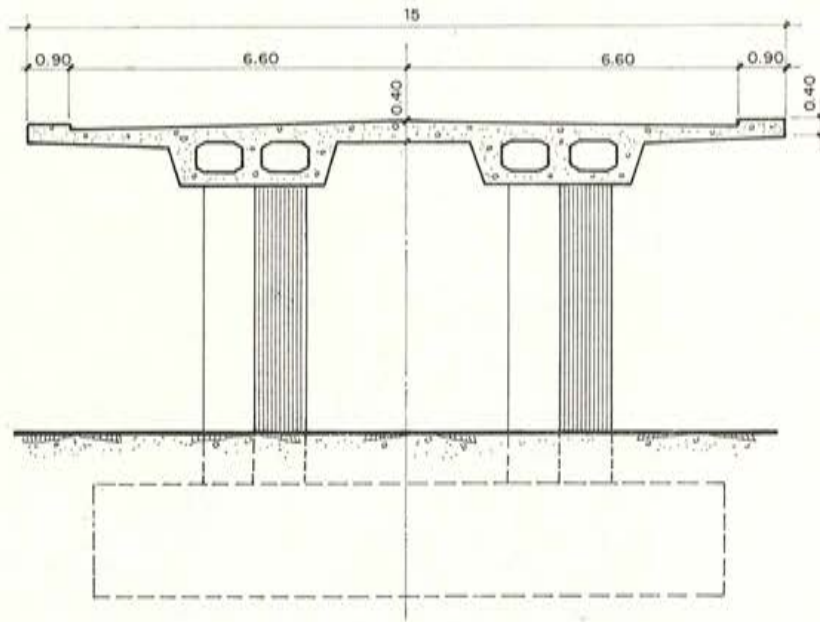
Sección transversal por el centro de un tramo (cotas en m).
